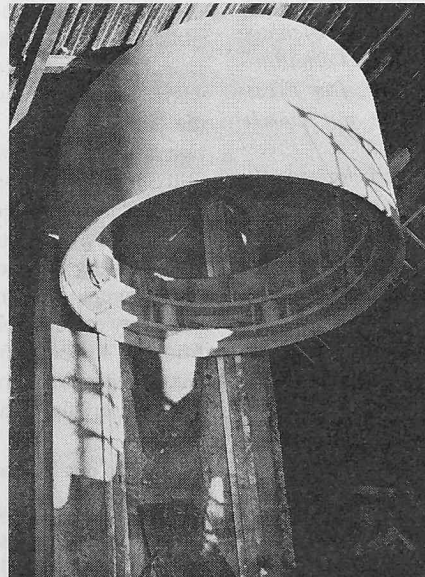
Betonwiderlager und hydraulische Pressen mit Druckring, oben links Gleichlauf-Synchronisieröl-pumpe
